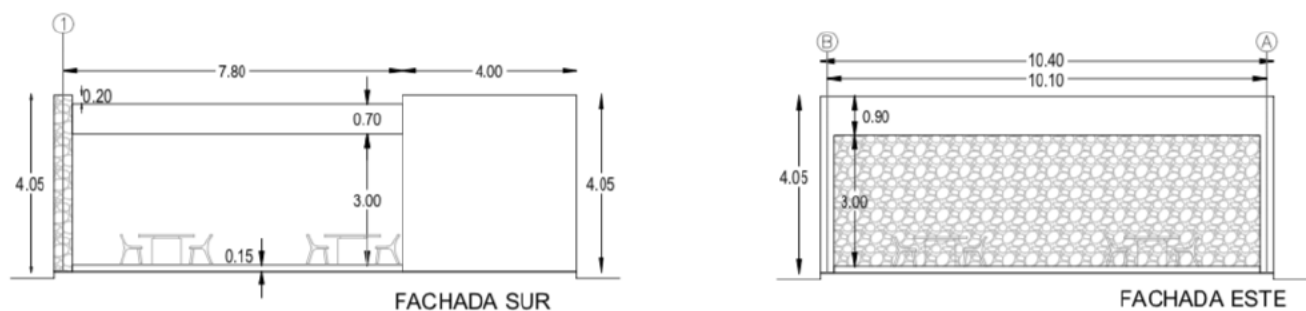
CORTE Y FACHADA SUR DE LA CASA CLUB.
